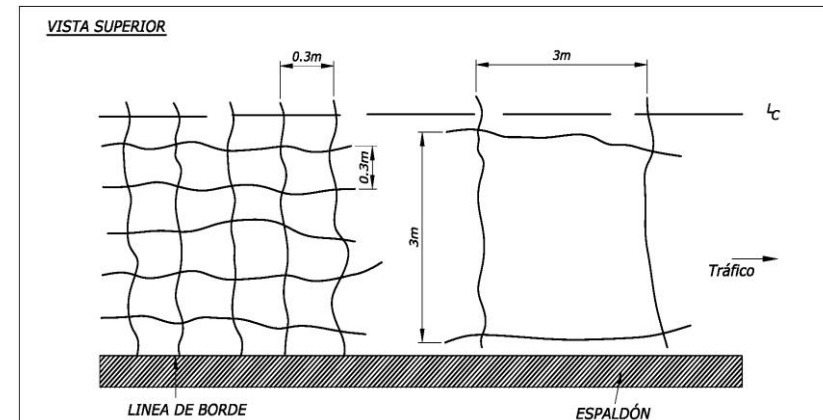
Esquema Grietas en Bloque – Pavimento Flexible
